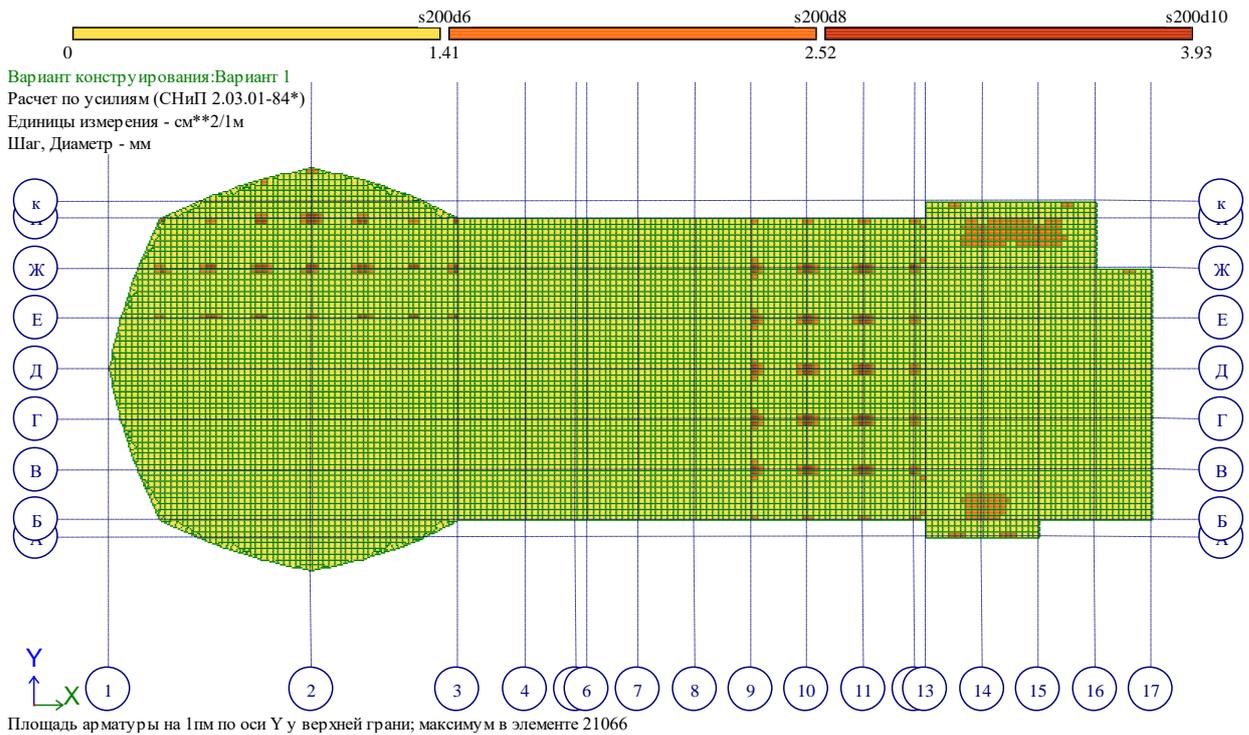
Площадь арматуры по оси Y у верхней грани
